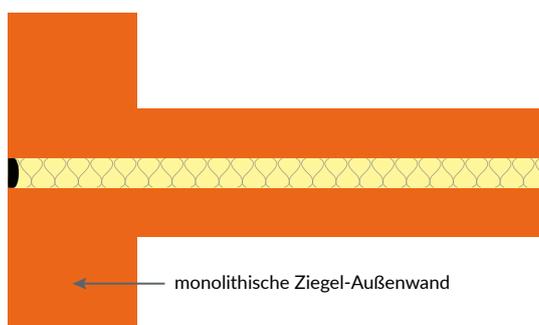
Grundriss üblicher Ausführungen mit bis zur Sohle durchgehender Trennfuge bei zweischaligen Konstruktionen (schematisch)
